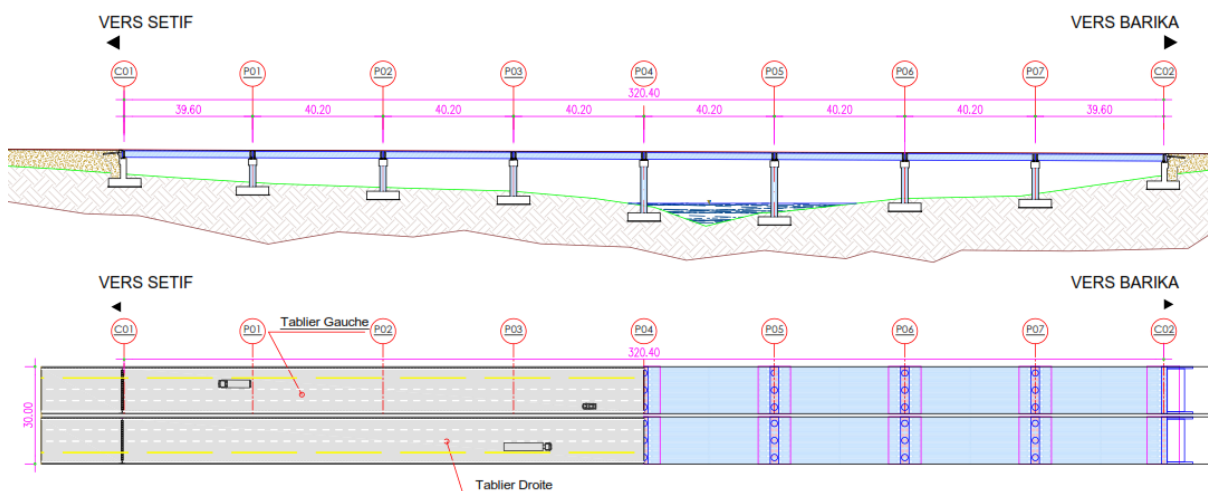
Coupe longitudinale et vue en plan de la variante VIPP
